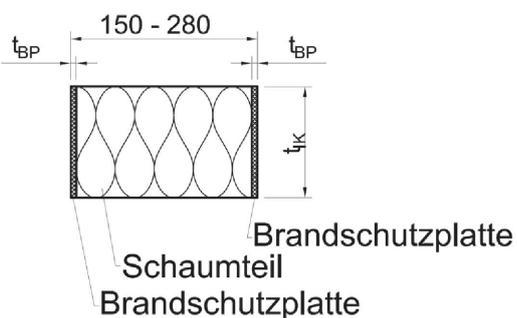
Schöck Isokorb® CXT Typ A Part Z für Attiken und Brüstungen
